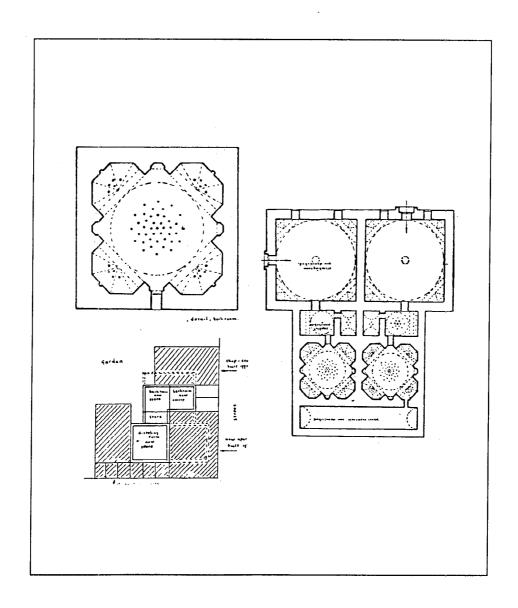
مسقط أفقي وقطاع لحمام بلاچاى (عن :ايفردى) .
